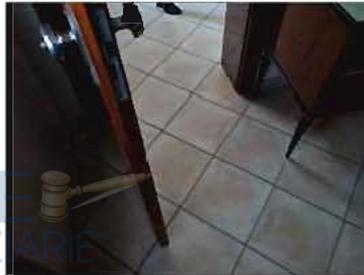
PIANO TERRA DETTAGLIO PAVIMENTAZIONI
